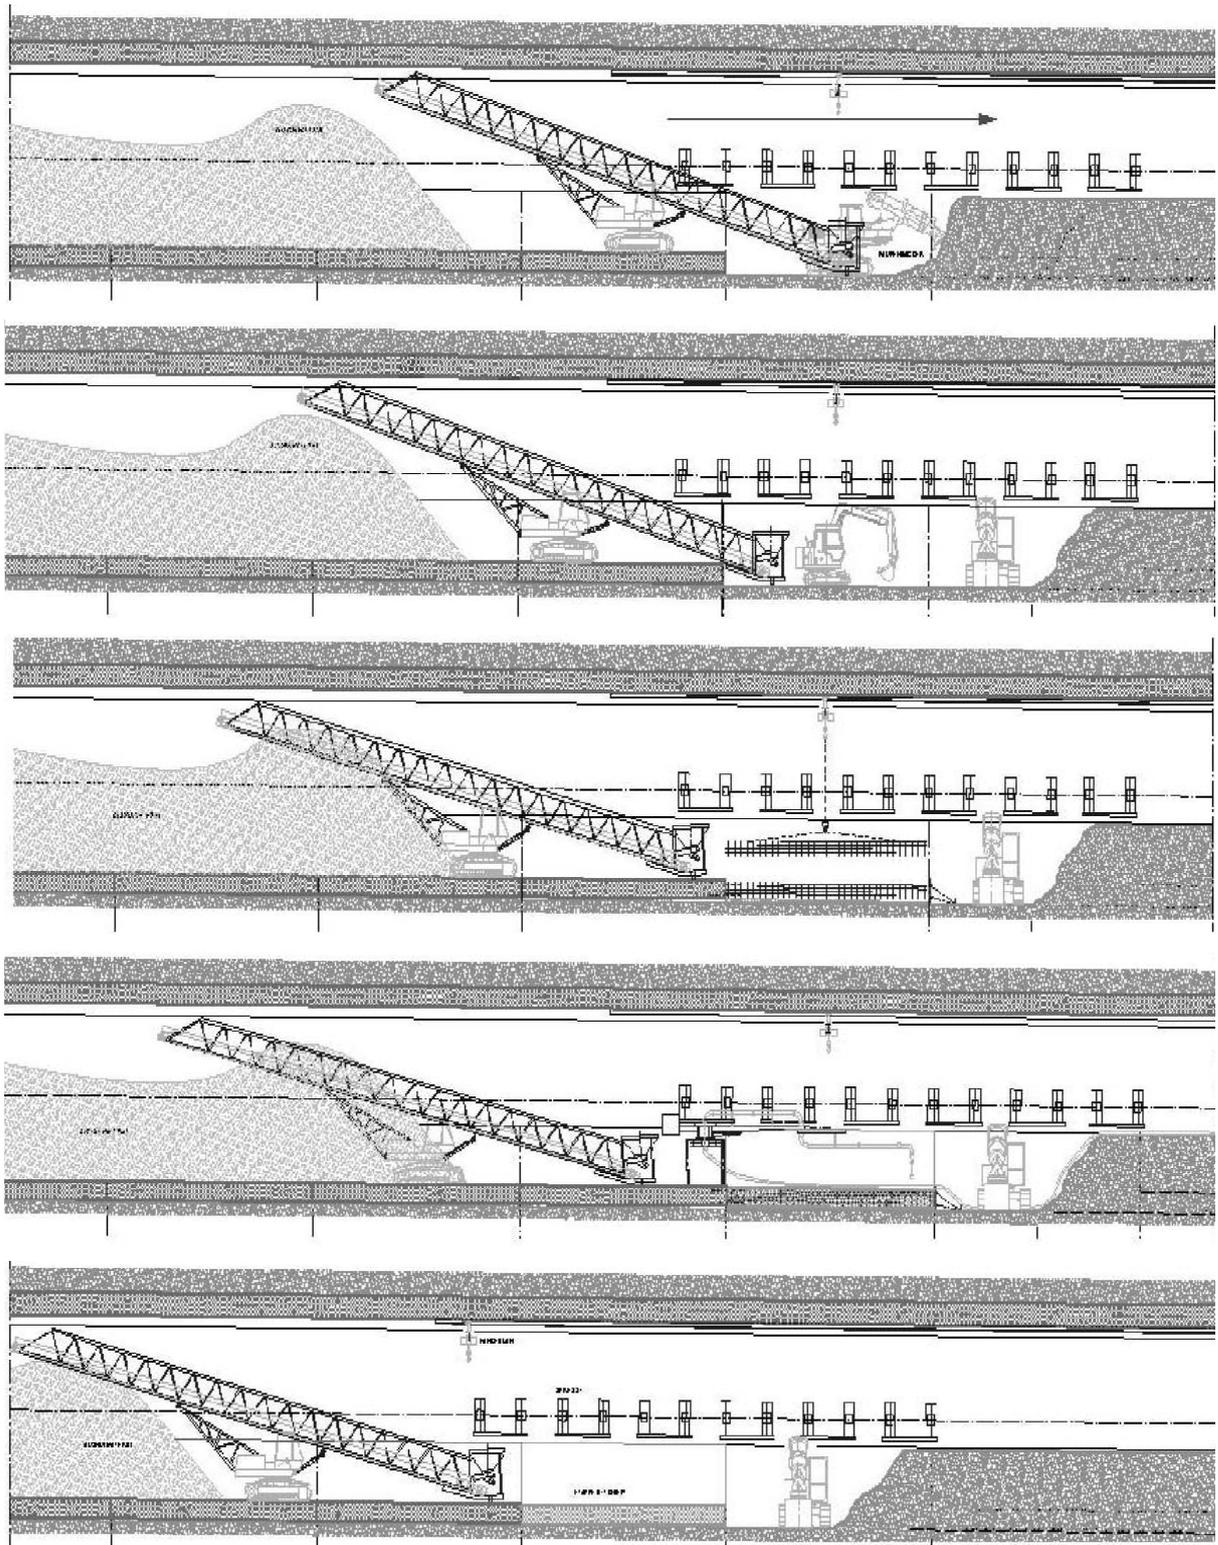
Phasen des Baubetriebs im Längsschnitt
